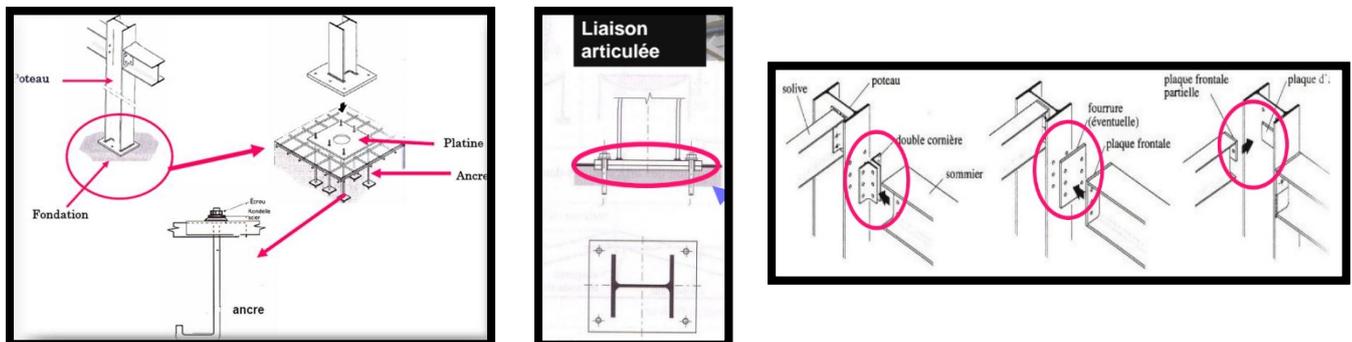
Assemblage poteau-fondation / Assemblage poteau-poutre
